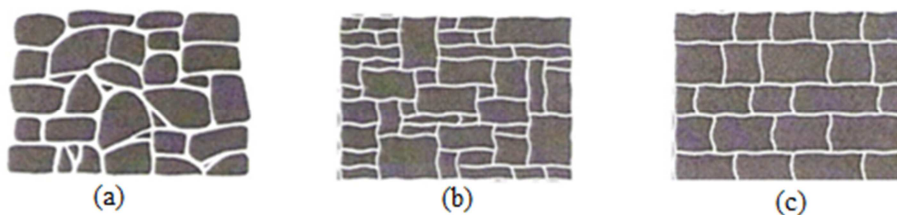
Sistemas construtivos: (a) Alvenaria irregular; (b) Alvenaria aparelhada; (c) Cantaria [5]
